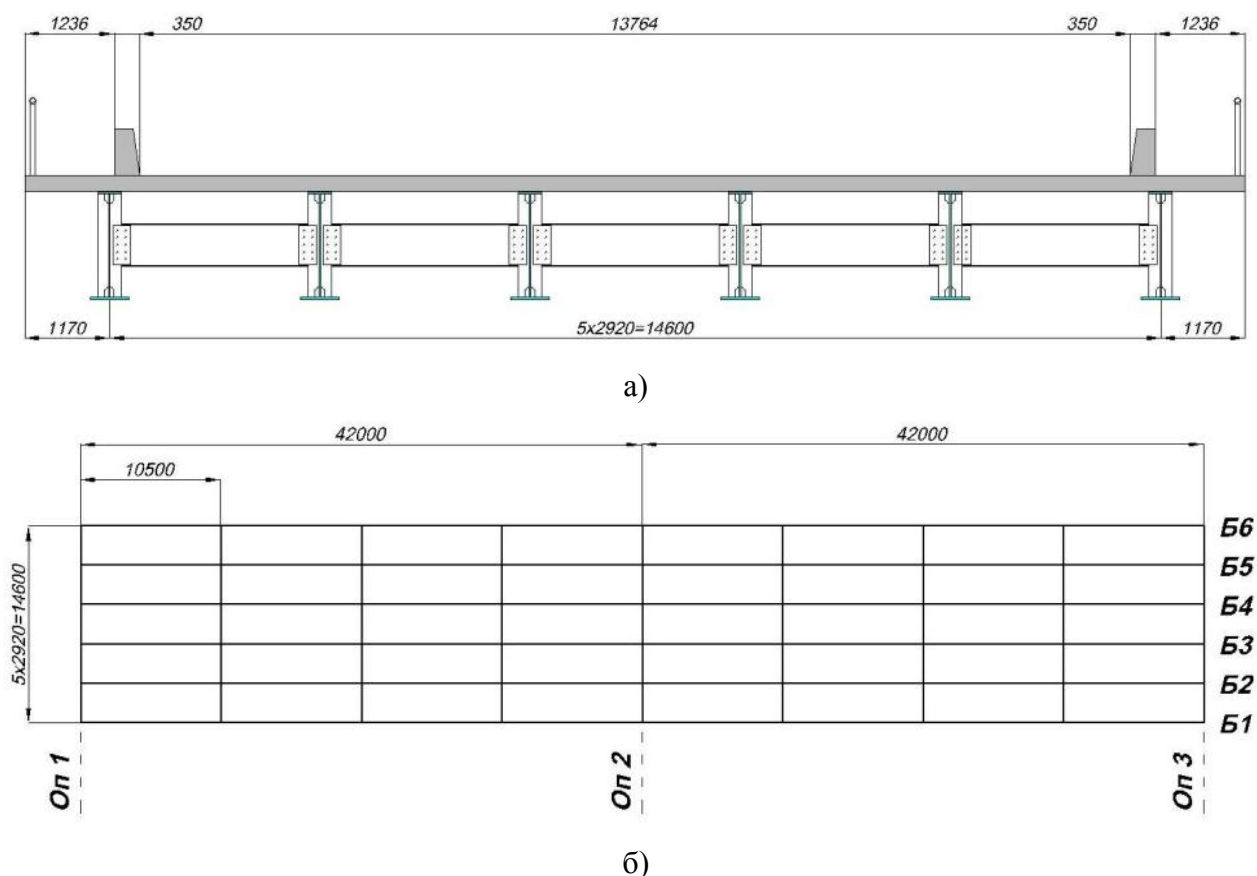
Поперечное сечение и схема неразрезного сталежелезобетонного пролетного строения для численных исследований: а – поперечное сечение; б – схема
